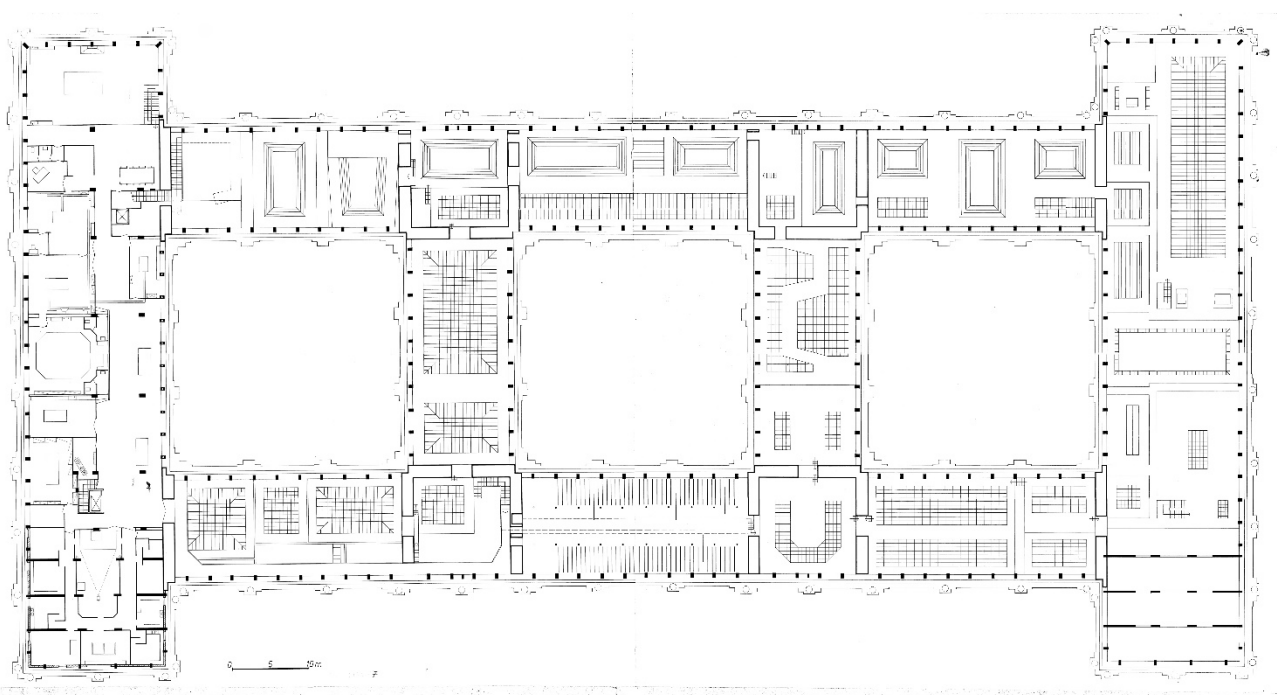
Pianta del sottotetto, progetto di E.B. De Felice, 1952-57, Archivio della Fondazione E.B. De Felice
